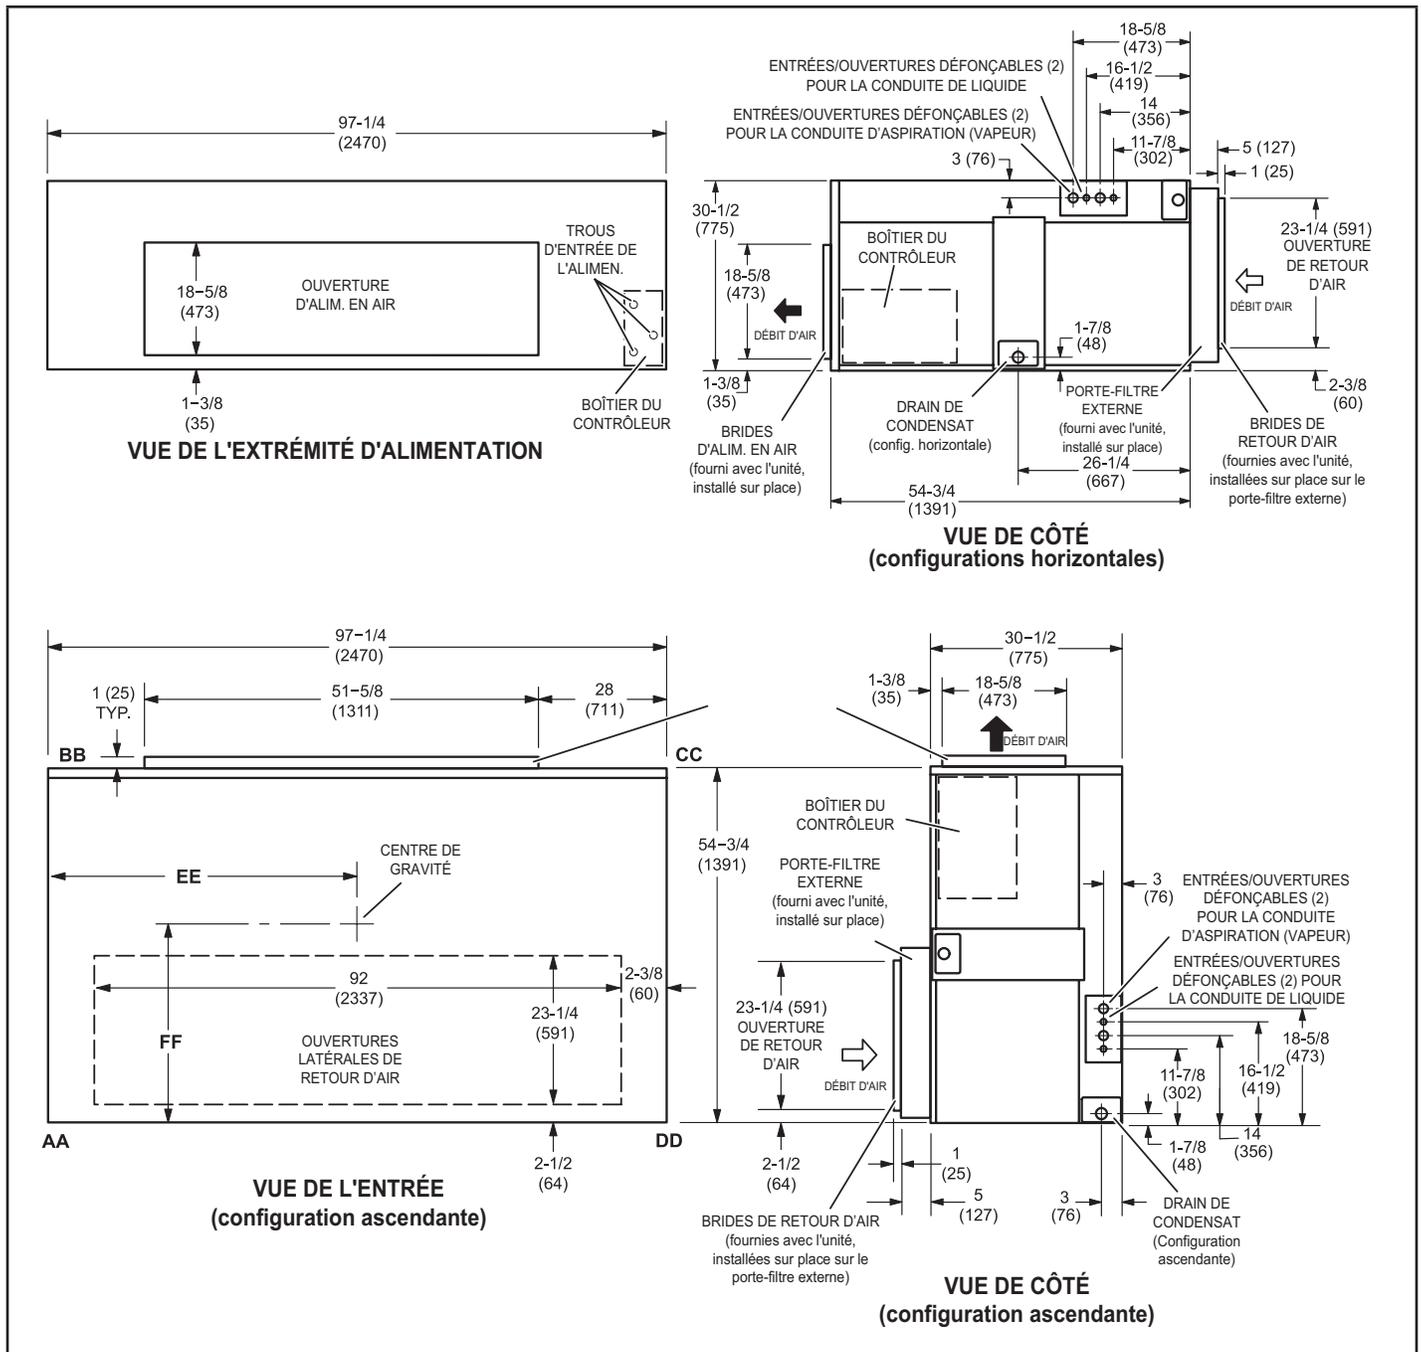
Dimensions de l'unité EL180-240KA- pouces (mm)
